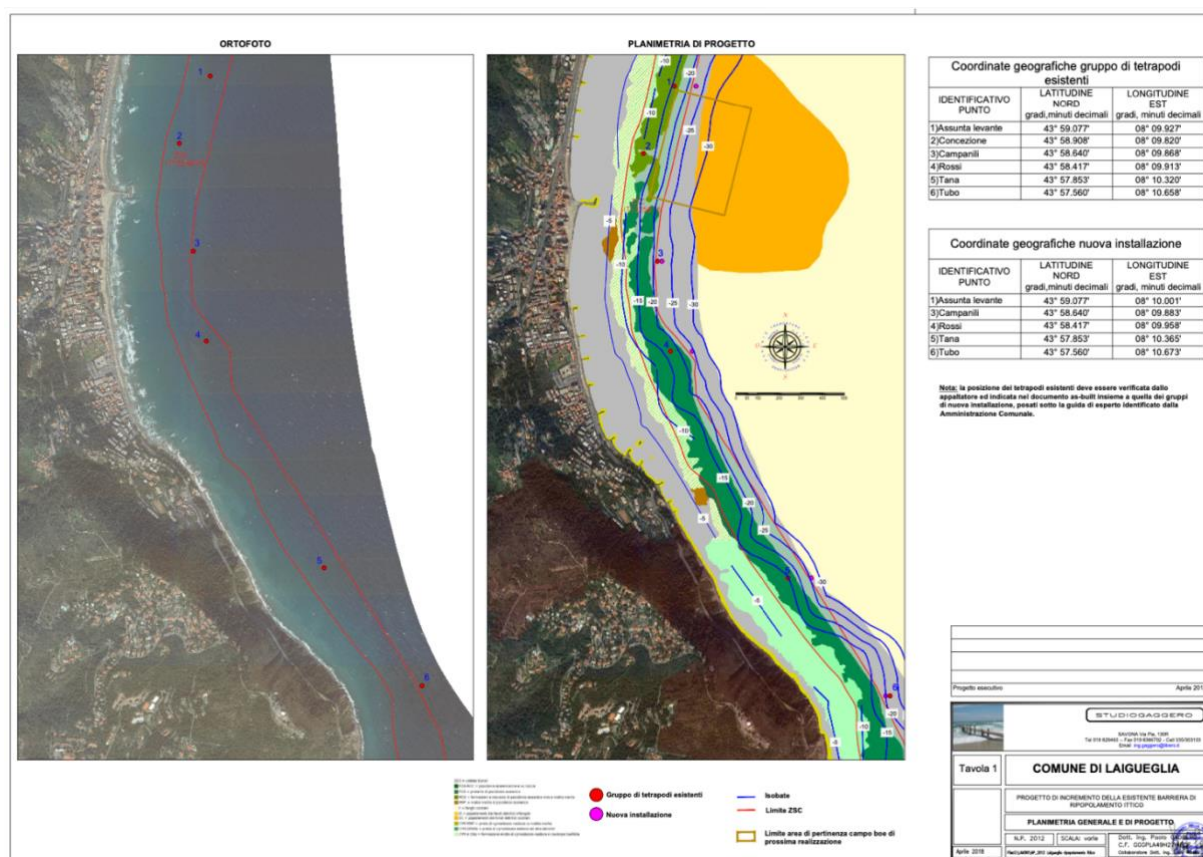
Planimetria e ortofoto dei punti di posa degli ammassi cementizi.
